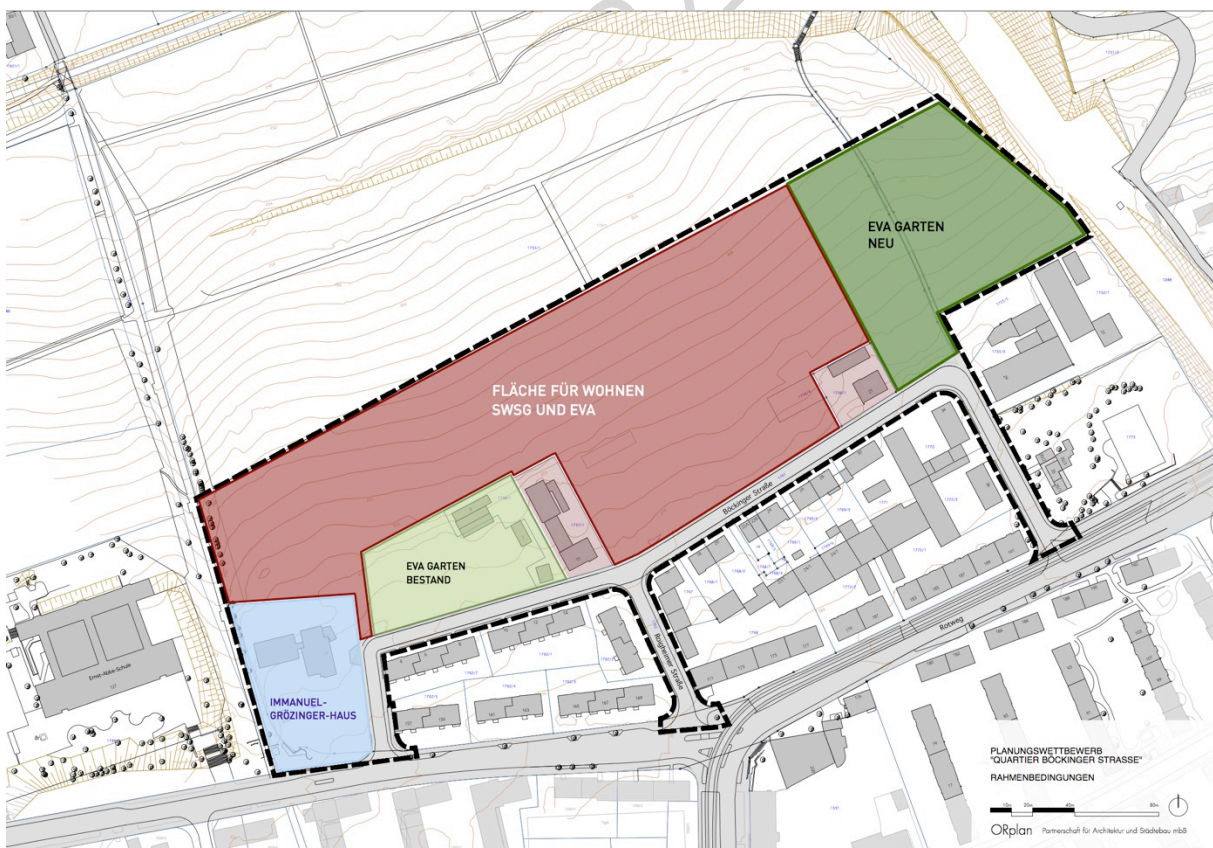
Abgrenzung und Lageplan Quartier an der Böckinger Straße
